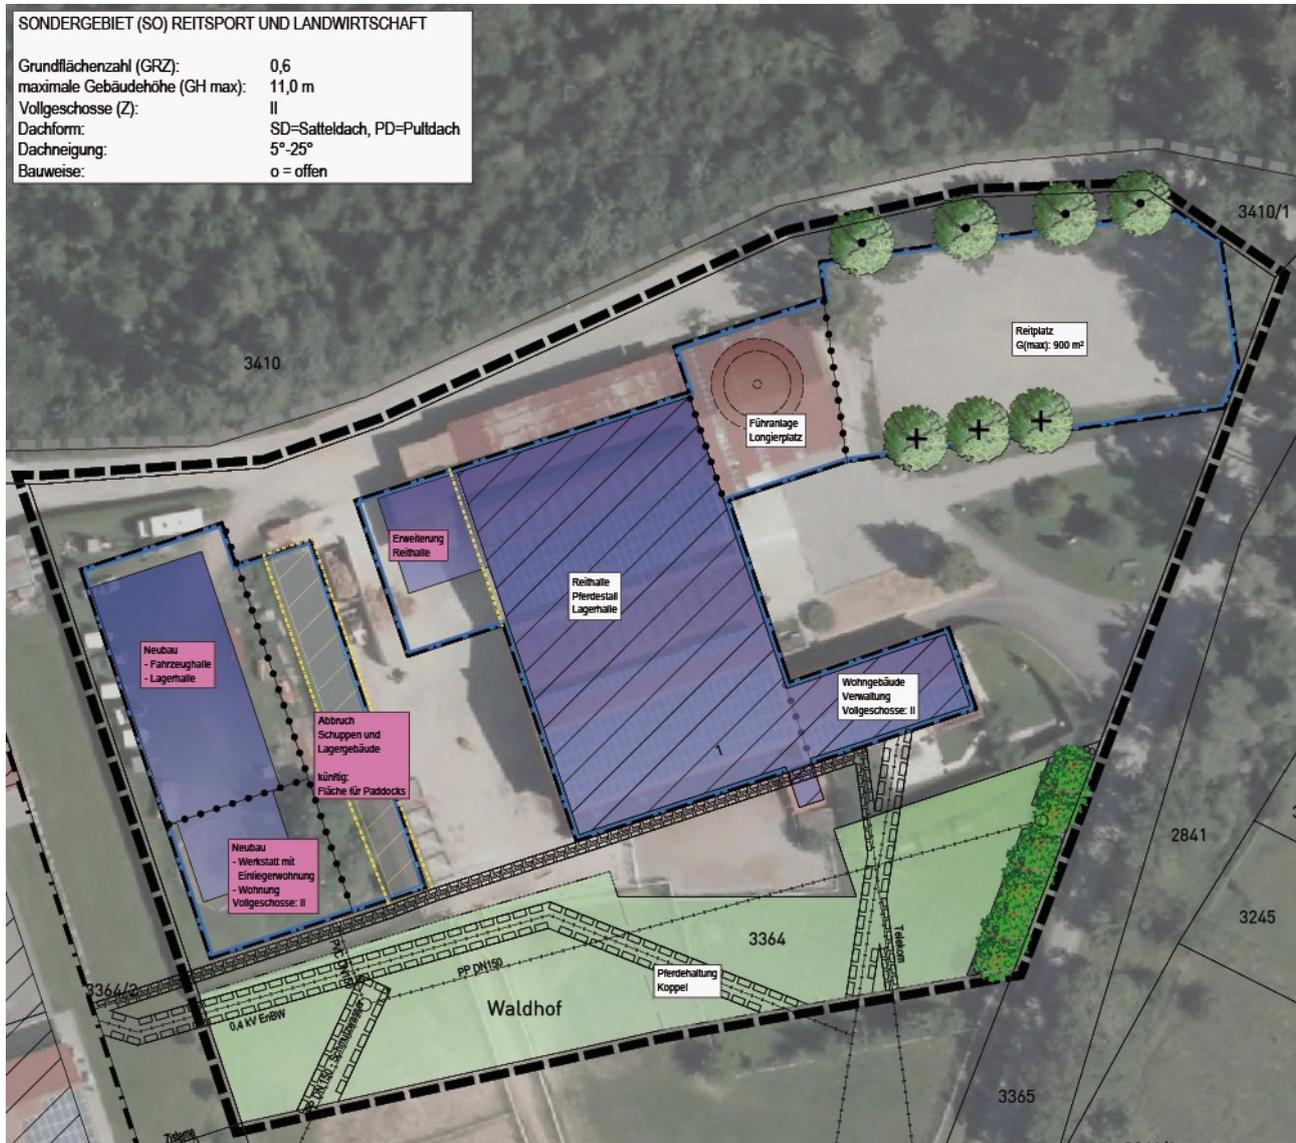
Ausschnitt aus dem Erschließungsplan
